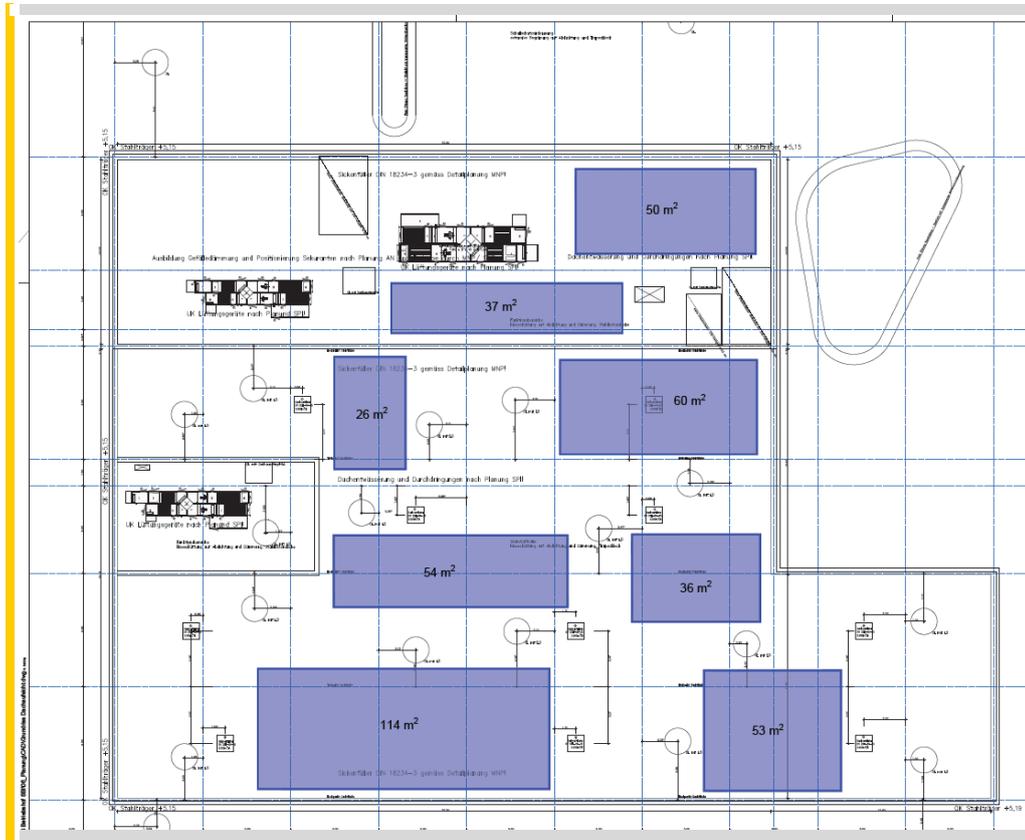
Mögliche Flächen zur Photovoltaiknutzung auf dem Werkstattgebäude
